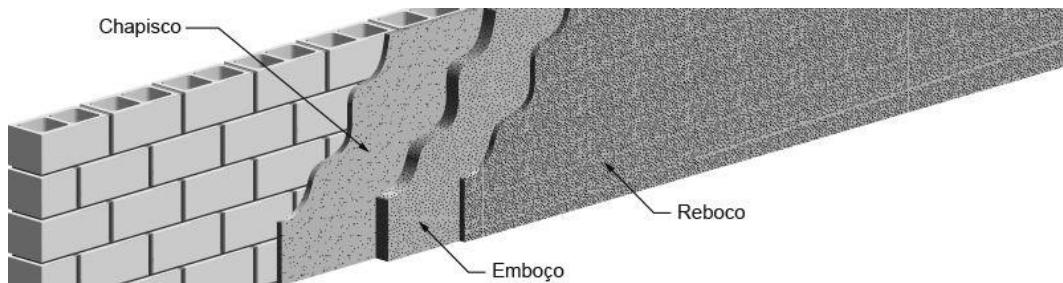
Camadas do revestimento da fachada (pintura aplicada sobre o reboco)
